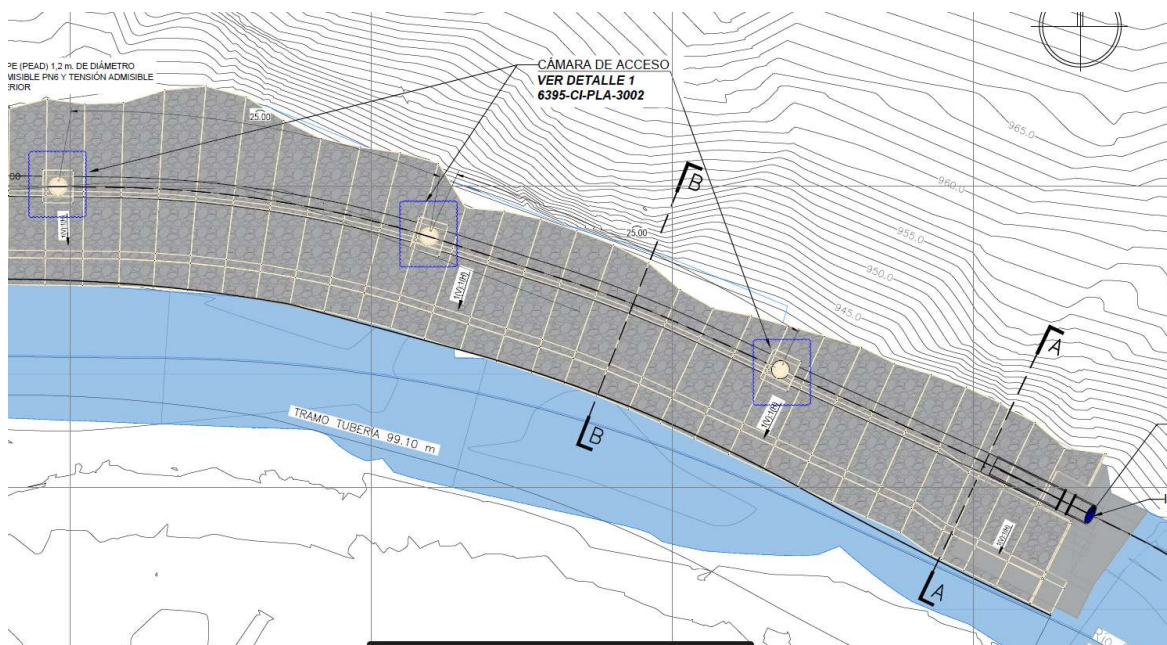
Ubicación en planta de las cámaras de acceso
